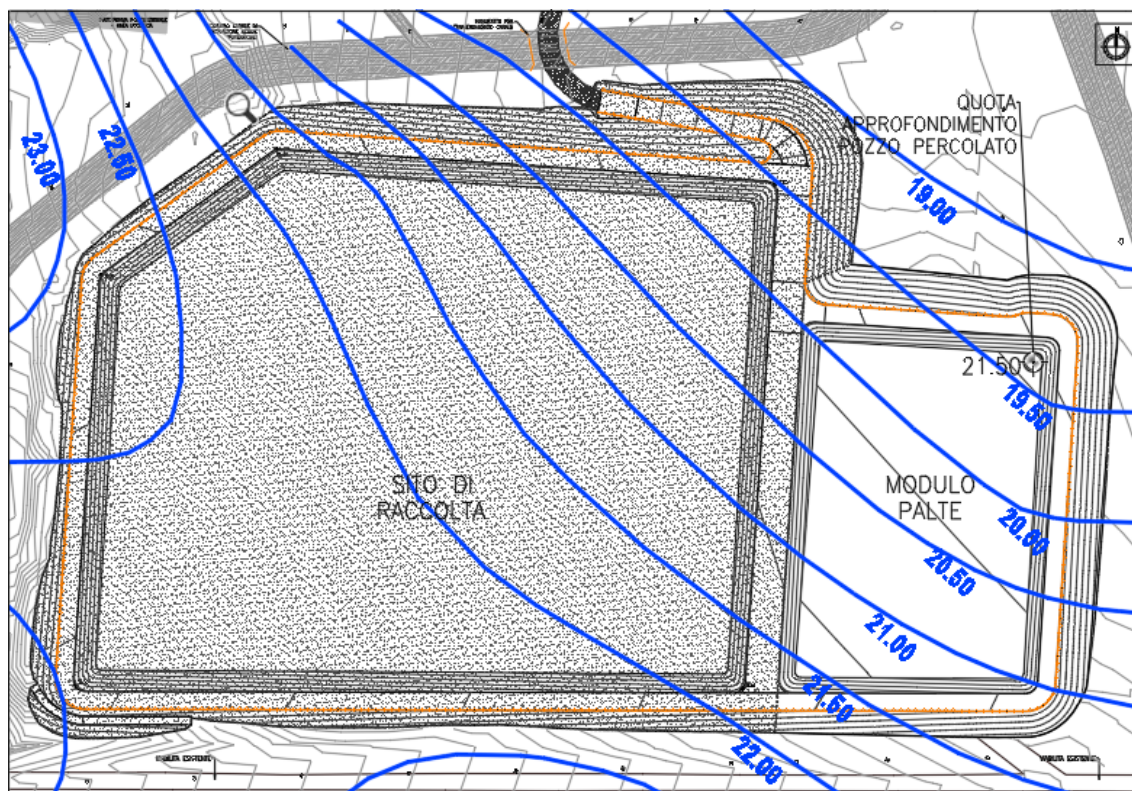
Planimetria piano posa barriera di confinamento del Modulo Palte Fosfatiche (MPF) e falda di progetto
